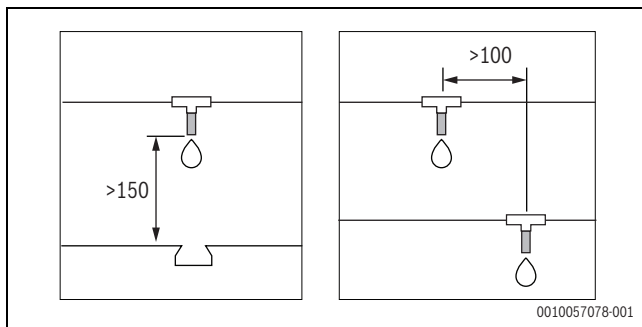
Abstände für die Installation von Frostschutzventilen in Millimetern (mm)
